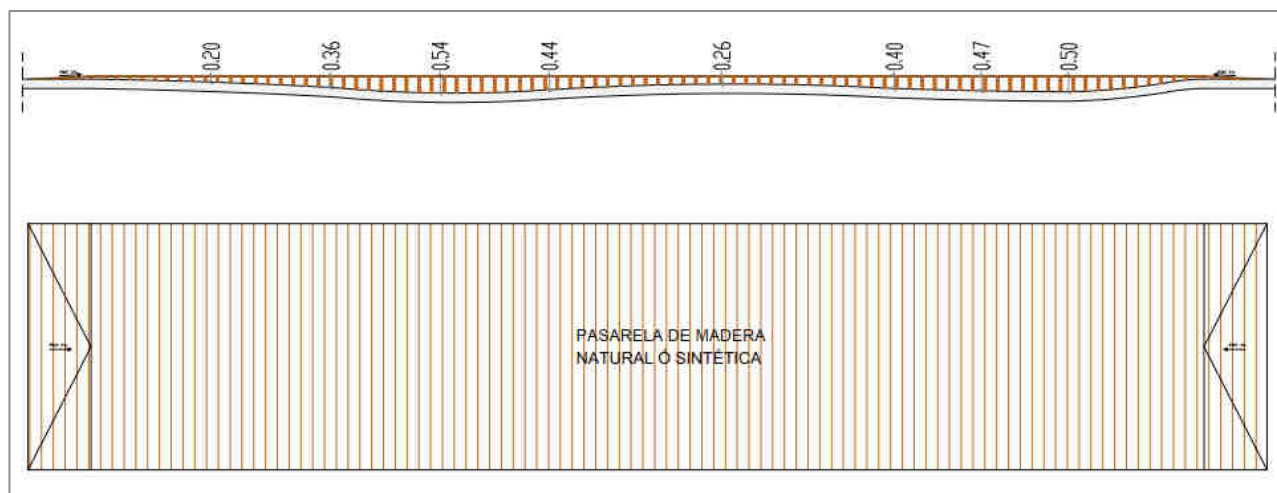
Planta y perfil longitudinal tipo de la pasarela de madera
